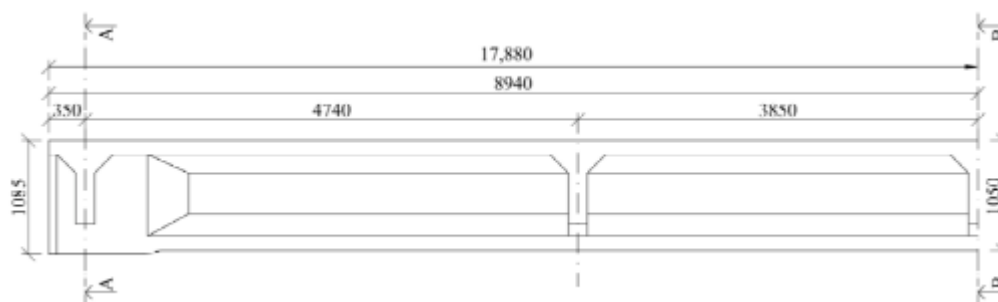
Plano en alzado de la sección a estudiar. (Fuente: Kralovanec, Moravčík, *et al.*, 2021)
